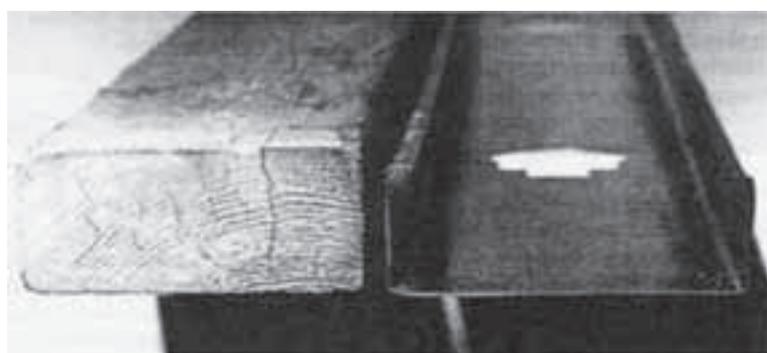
Perfis estruturais de madeira e aço galvanizado (Fonte: Roberl Scharff)
